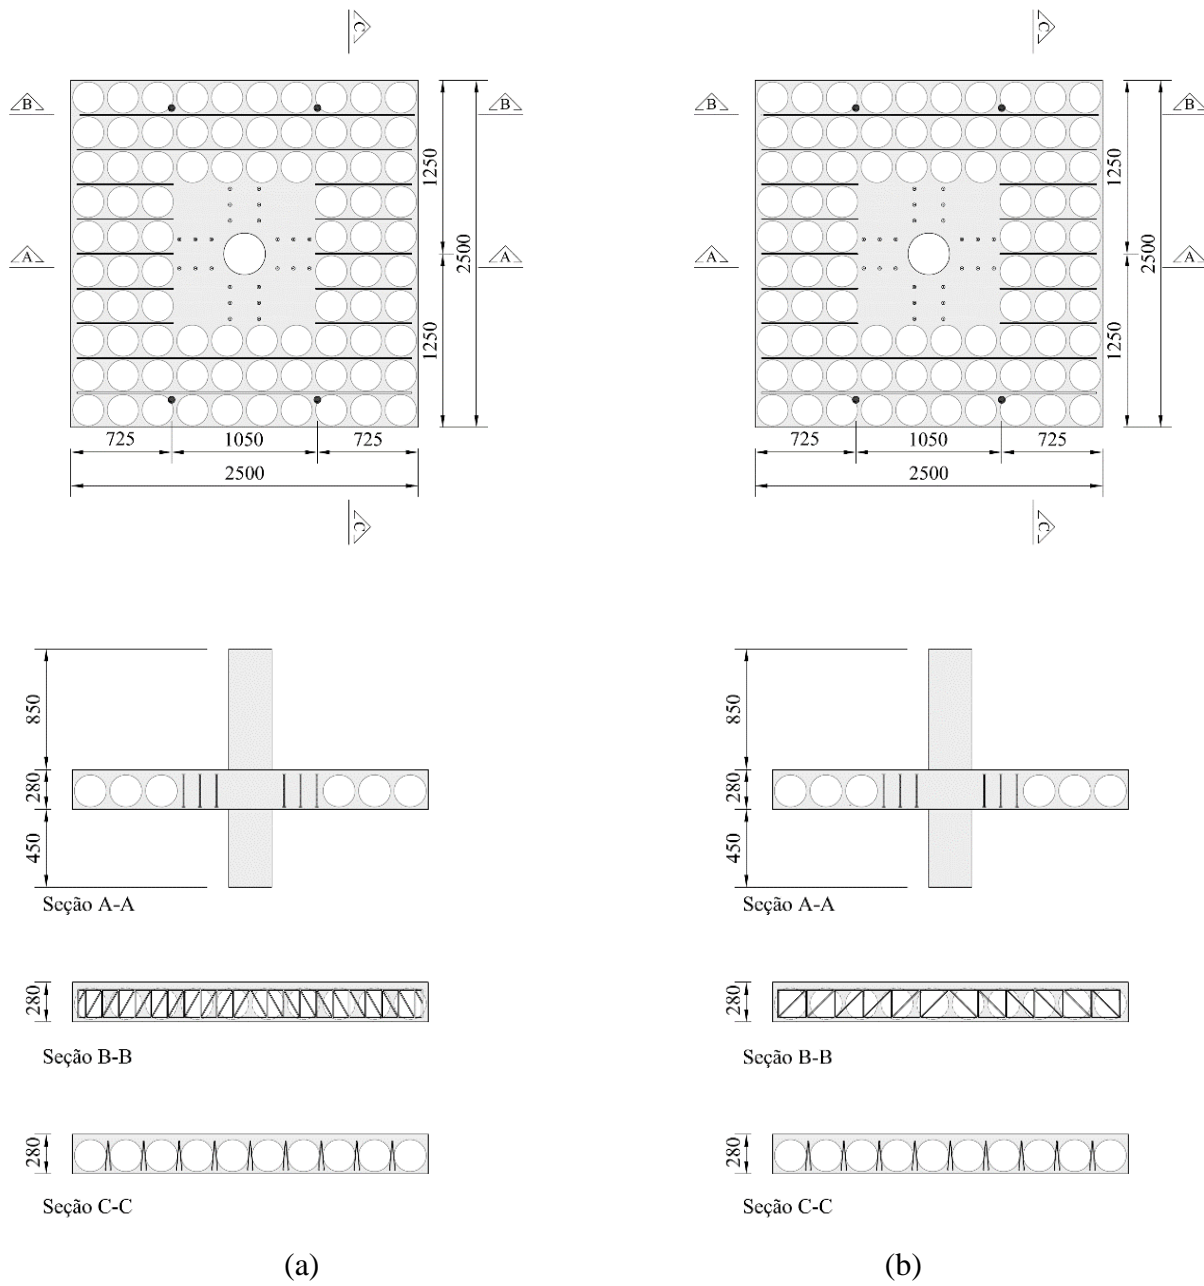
Planta e cortes das lajes (a) BD-A02 (b) BD-A03.
